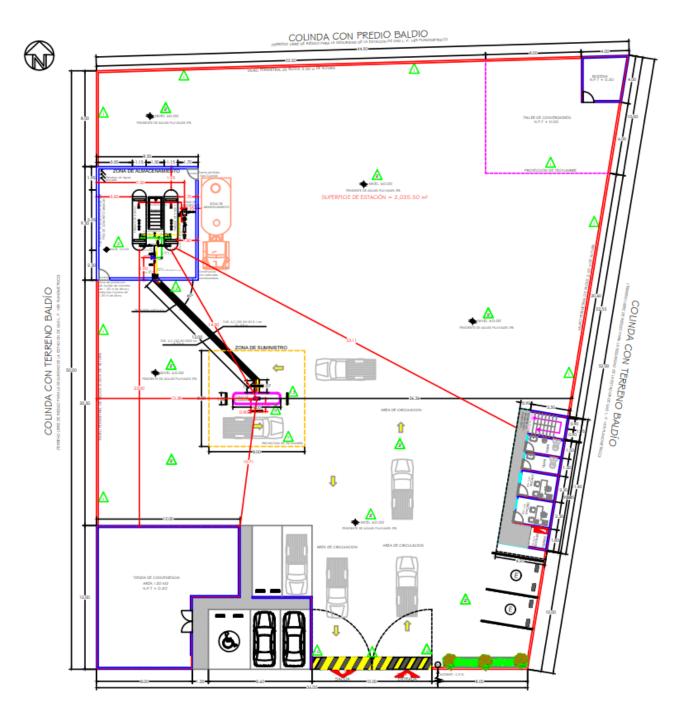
Plano de la planta general de la Estación de Gas L.P. para carburación
